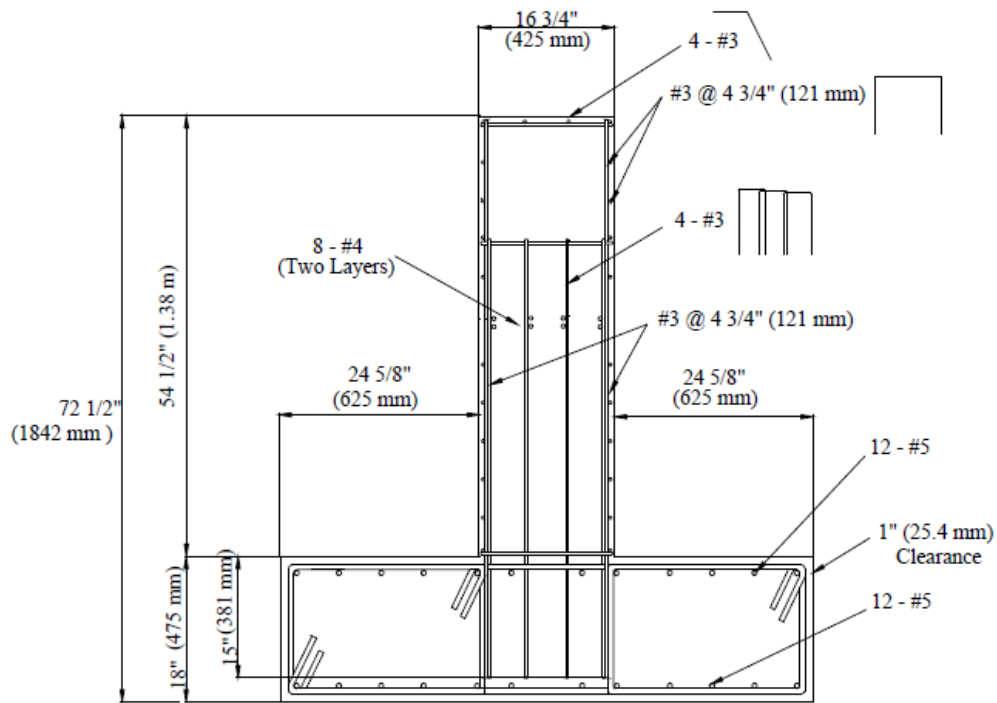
Sección A-A de Refuerzos – Serie 4 Externa (Bozorgzadeh et al., 2007).
